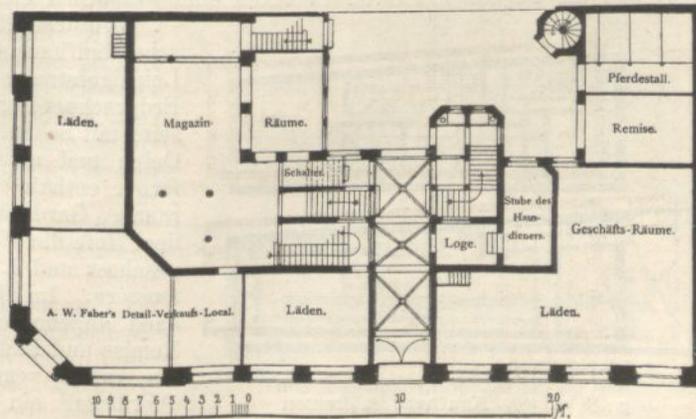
Grundriss vom Erdgeschoss.
